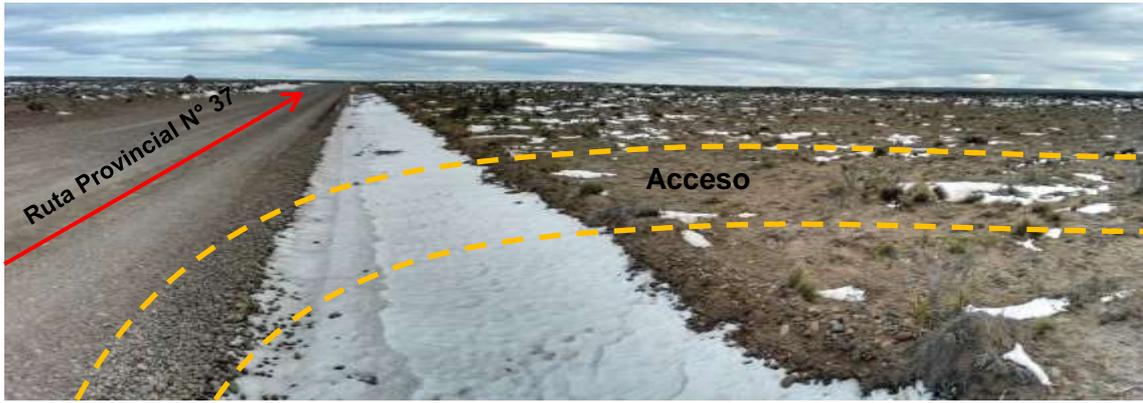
Vista panorámica del futuro acceso al edificio de la SET.
